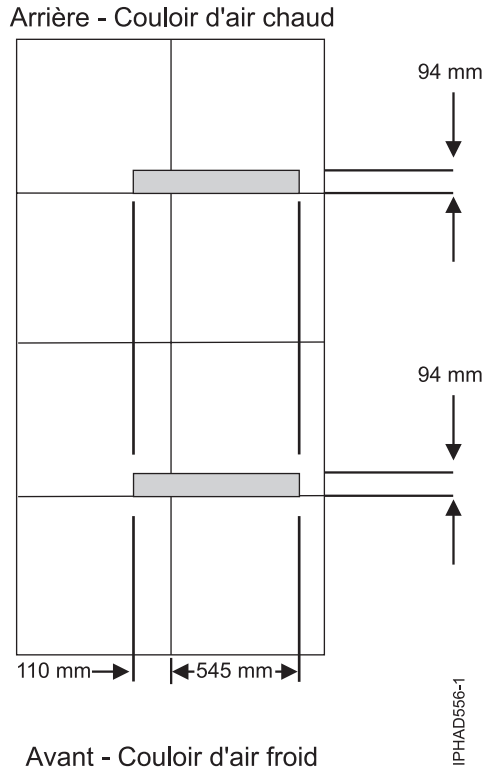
Positionnement des découpes de câble pour dalles de plancher de 610 mm
